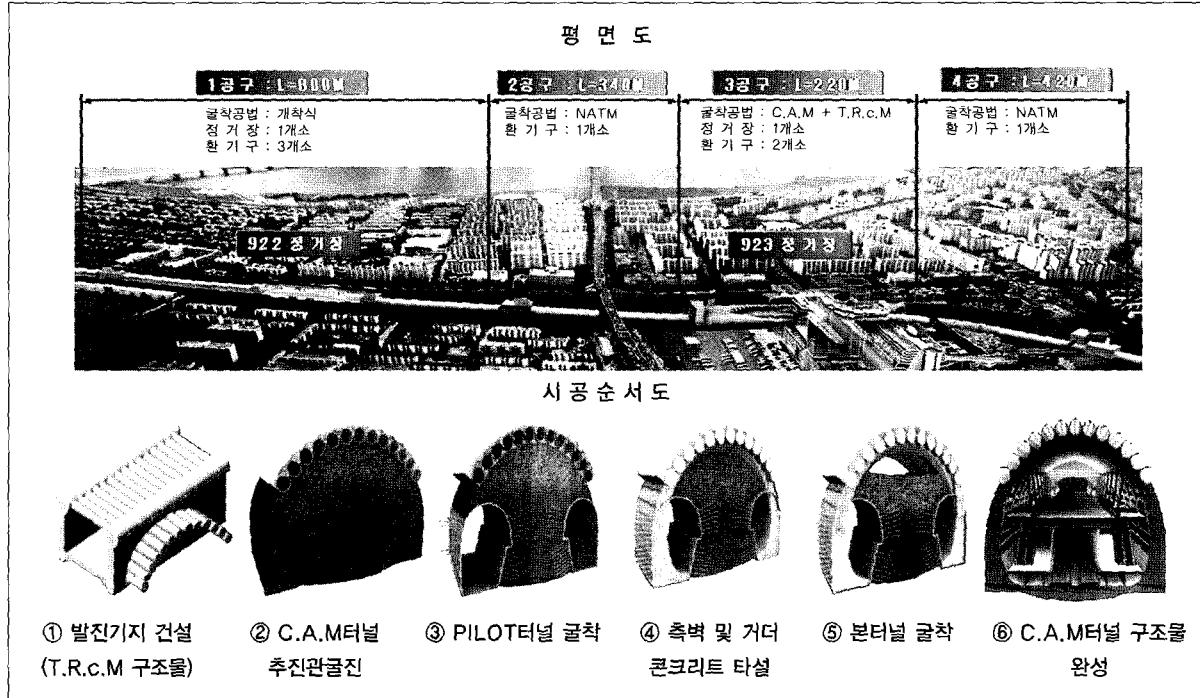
서울지하철 9호선 913공구 평면도 및 시공 순서도
